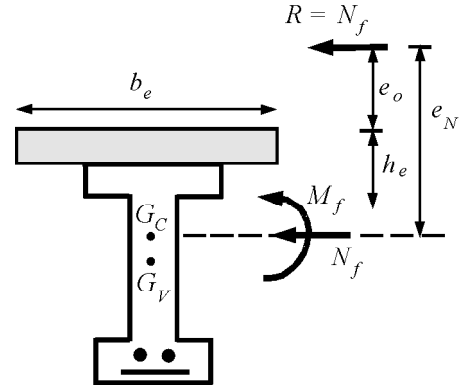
Configuración de la sección fisurada en el estado D.
